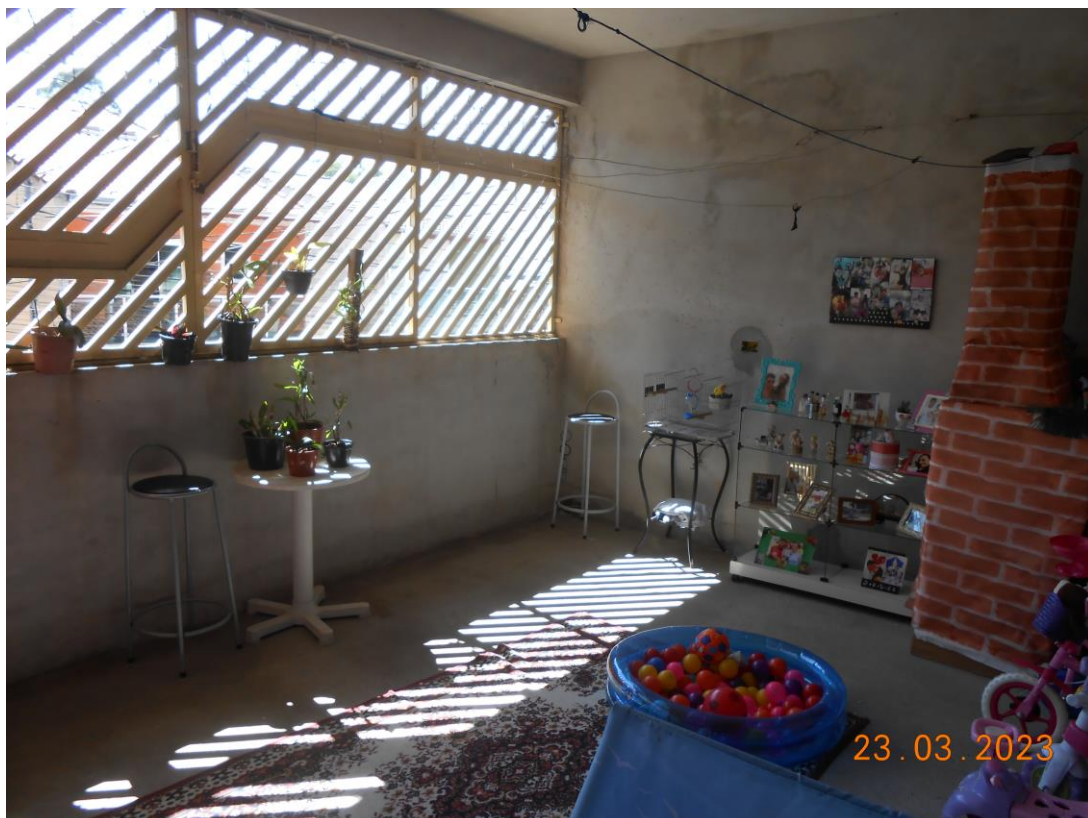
VARANDA / LAZER, PVT SUPERIOR.
